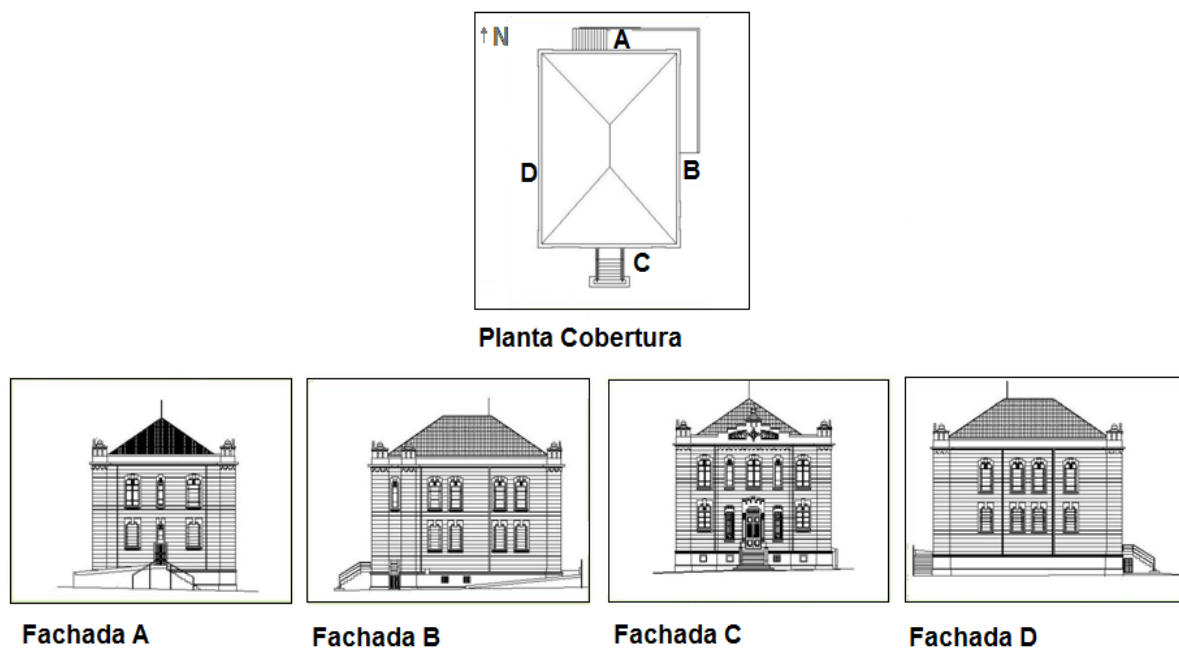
Mapa base:fachadas e planta de cobertura. Fonte: Projeto de Restauro do Antigo Fórum e Cadeia de Paraguaçu Paulista-SP.
